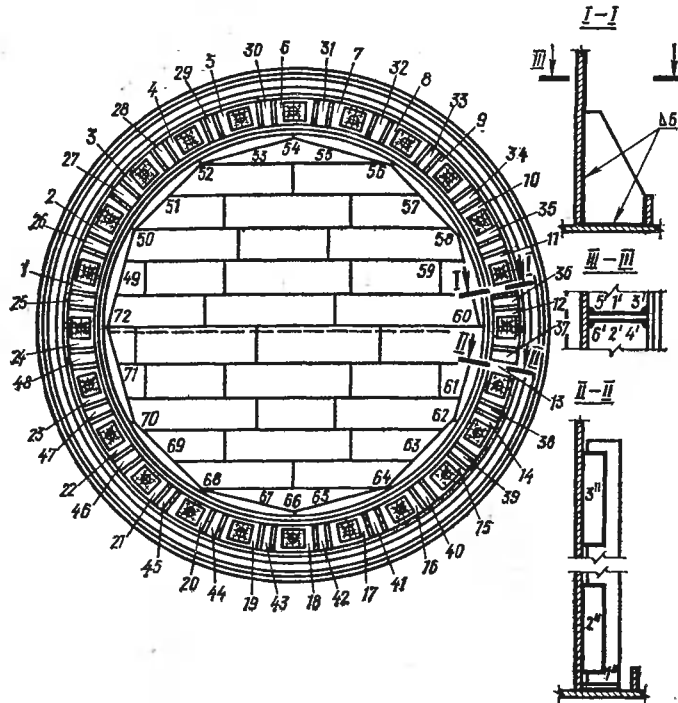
Последовательность приварки косынок и стоек колокола к нижнему горизонтальному листу и корпусу колокола: позиции 1—48 — последовательность приварки косынок; позиции 49—72 — последовательность приварки стоек; 1—6 — порядок приварки косынок; 1''—3'' — порядок приварки стоек.
